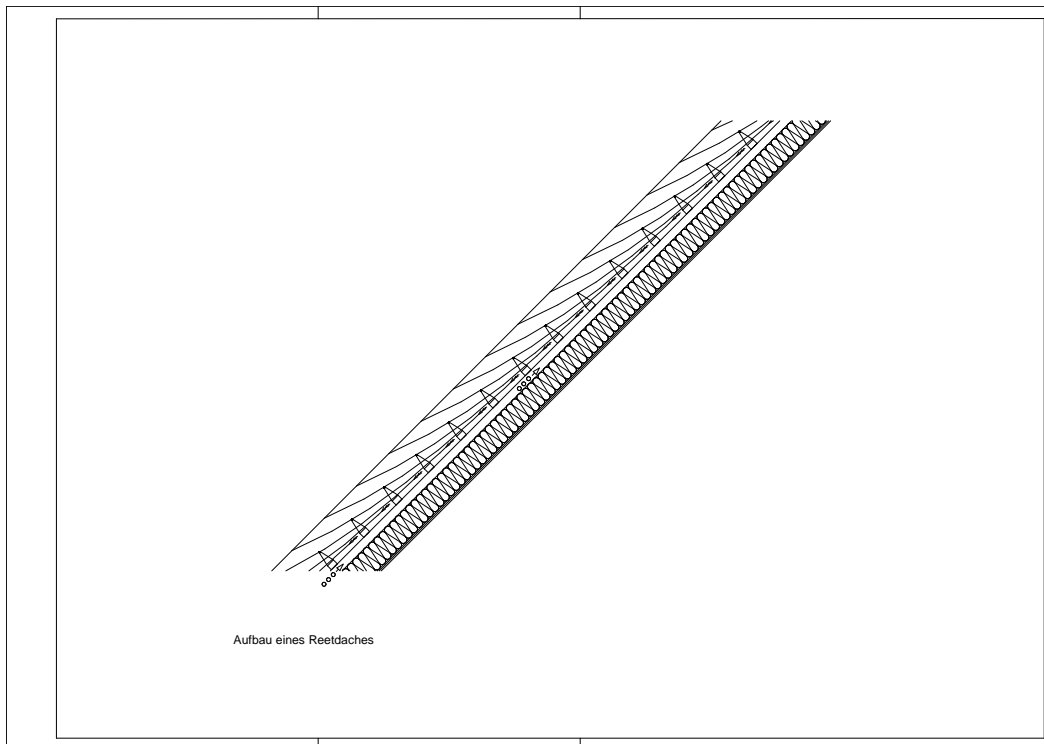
Gebundenes Reetdach (mit Lüftungsprofil)
